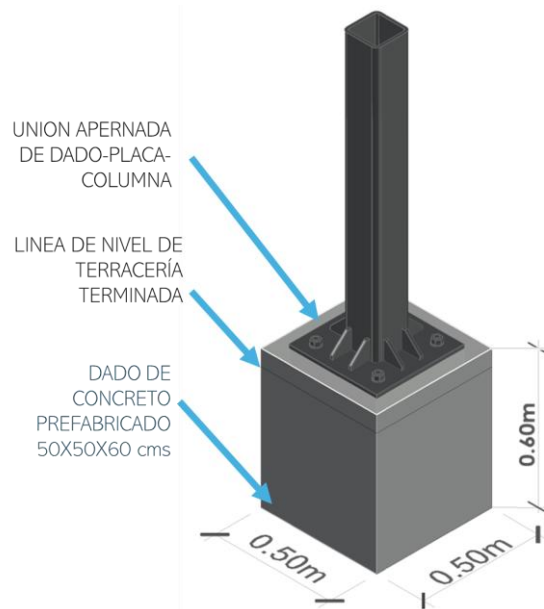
Dado de Concreto con Anclaje de Pernos. Fuente: Elaboración propia
